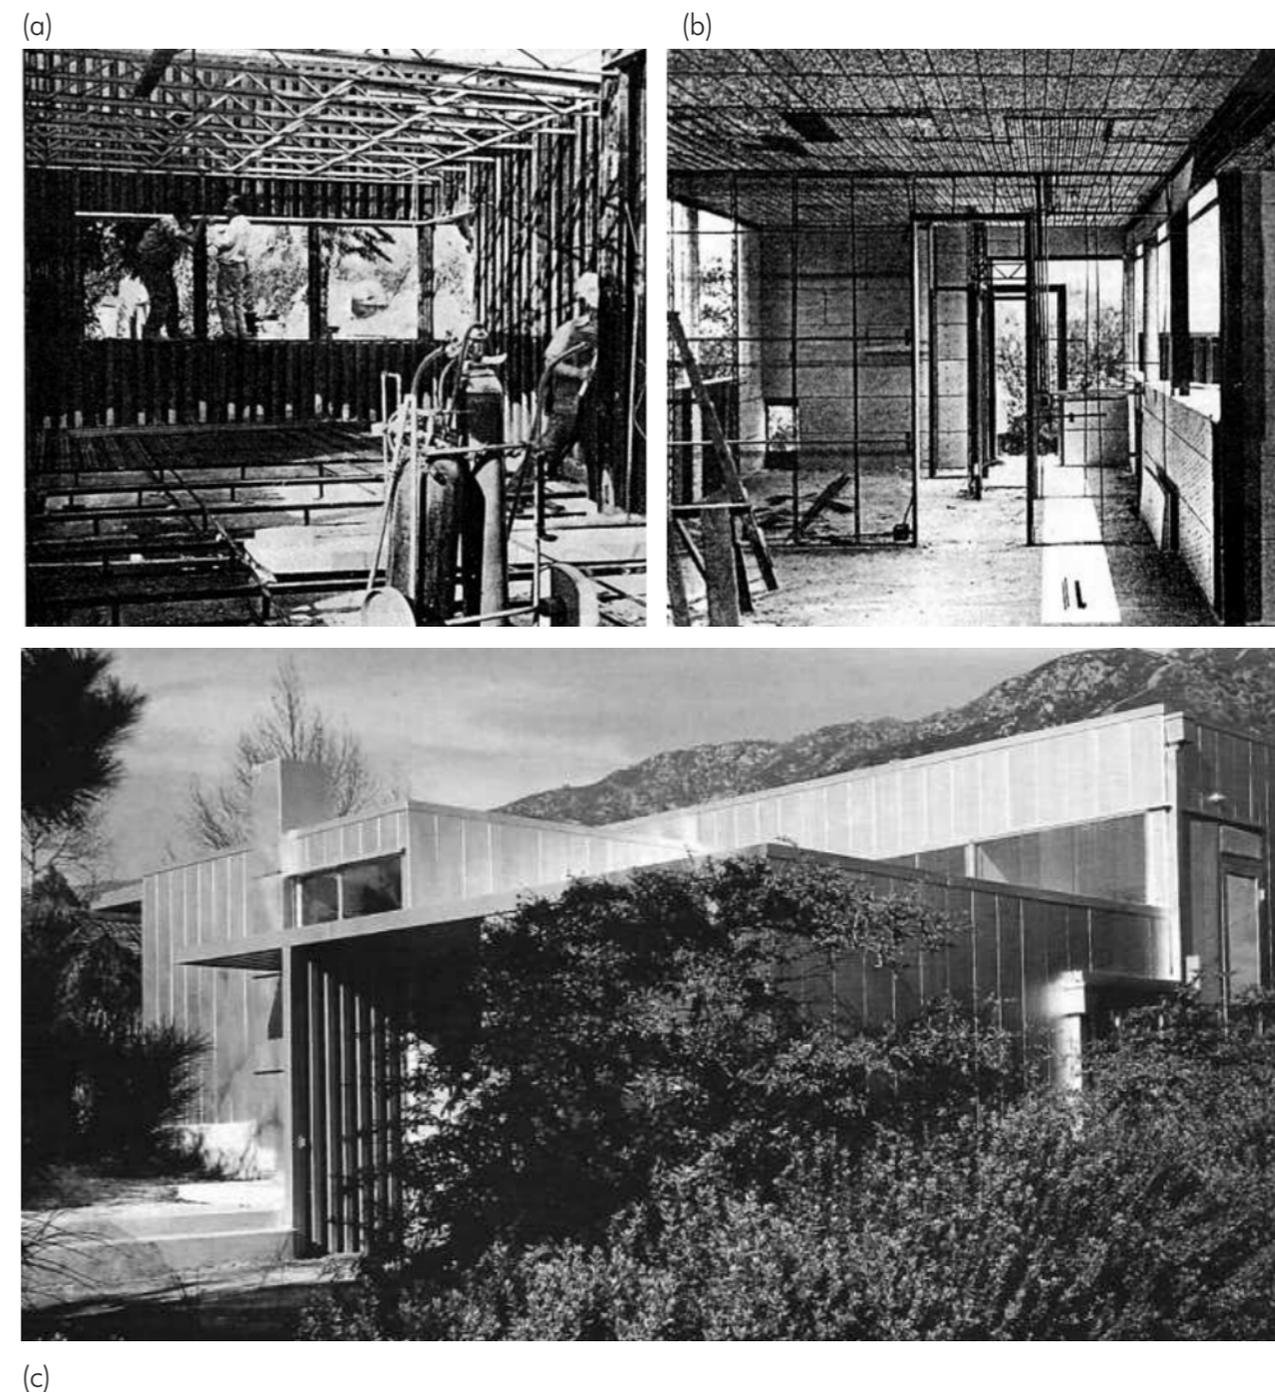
| (a) Montagem dos painéis metálicos da Casa Beard; (b) Montagem dos fechamentos internos; (c) Perspectiva mostrando a Casa Beard finalizada. Fontes: *imagens (a,b)* BOESIGER (1951, p.32); *imagem (c)* LAMPRECHT (2000, p. 36). Montagem do autor, 2021.
